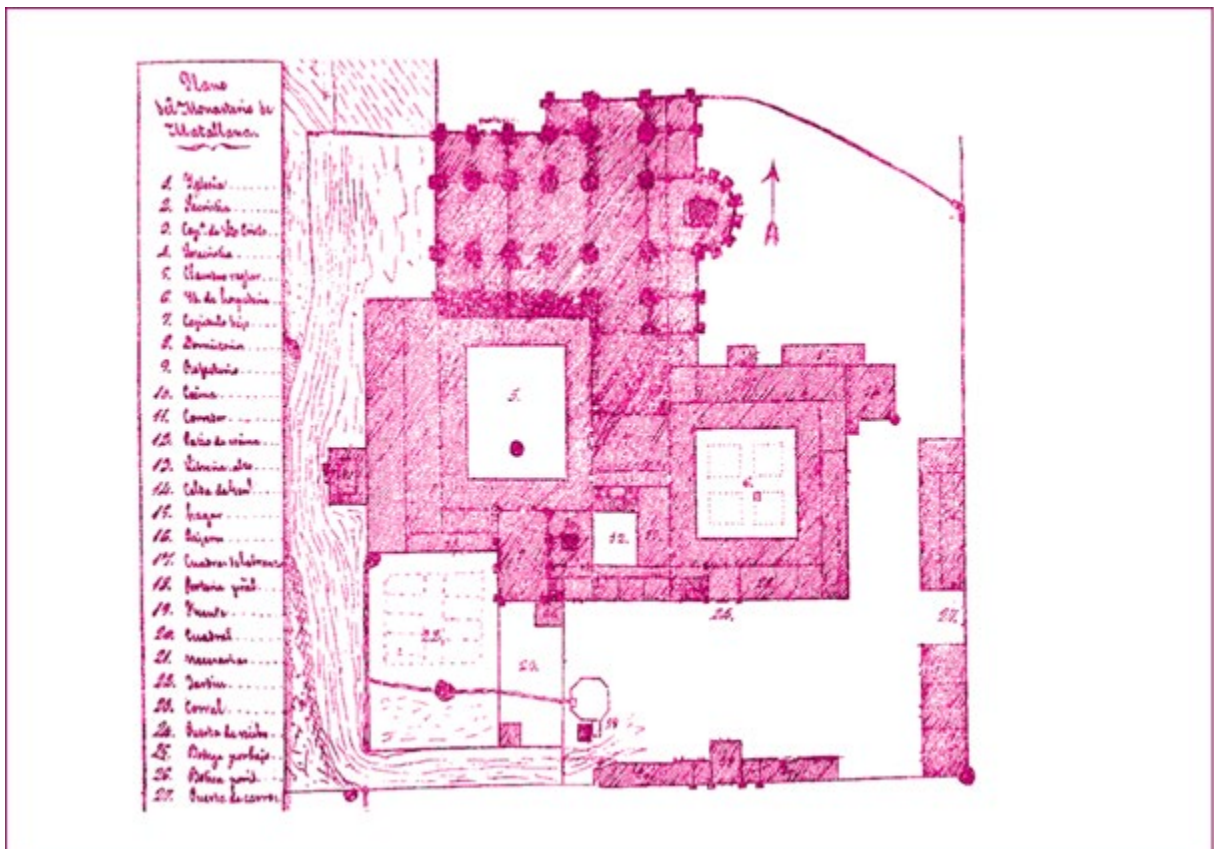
Matallana, Santa María, Grundriss Gesamtkomplex, Rekonstruktion nach F. Antón, 1942.
